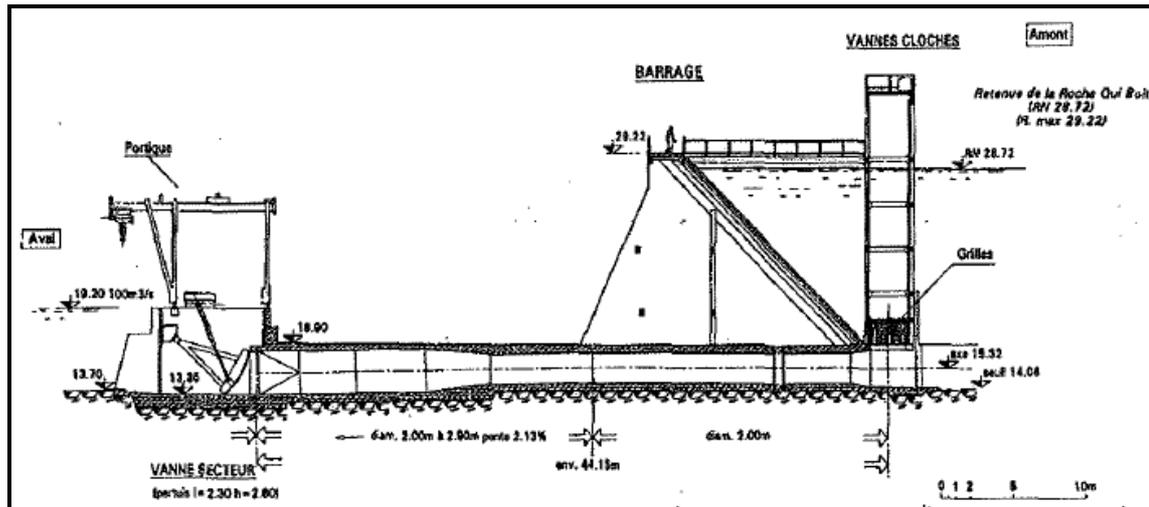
Vue en coupe du barrage de la Roche-qui-Boit
